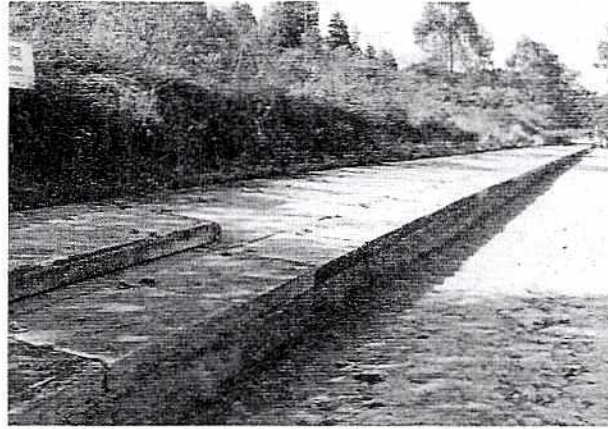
Lugar de disposición temporal para secado de material deslizado
